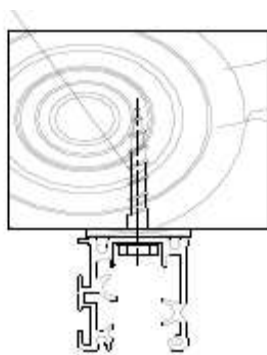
System zabudowy w położeniu zamkniętym (elewacja)
